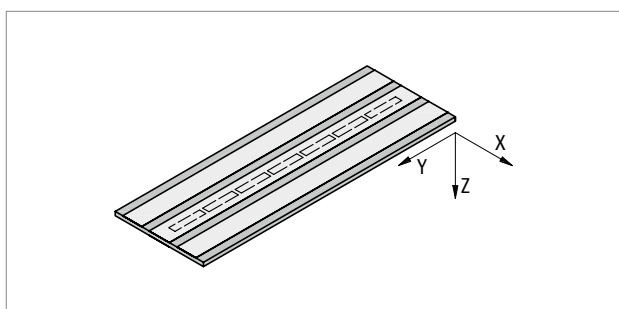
Schöck Tronsole® typ D-H: Půdorys prvku
